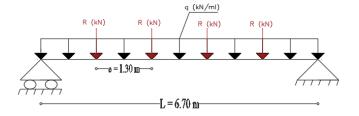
Schéma statique de la poutre la plus sollicitée
